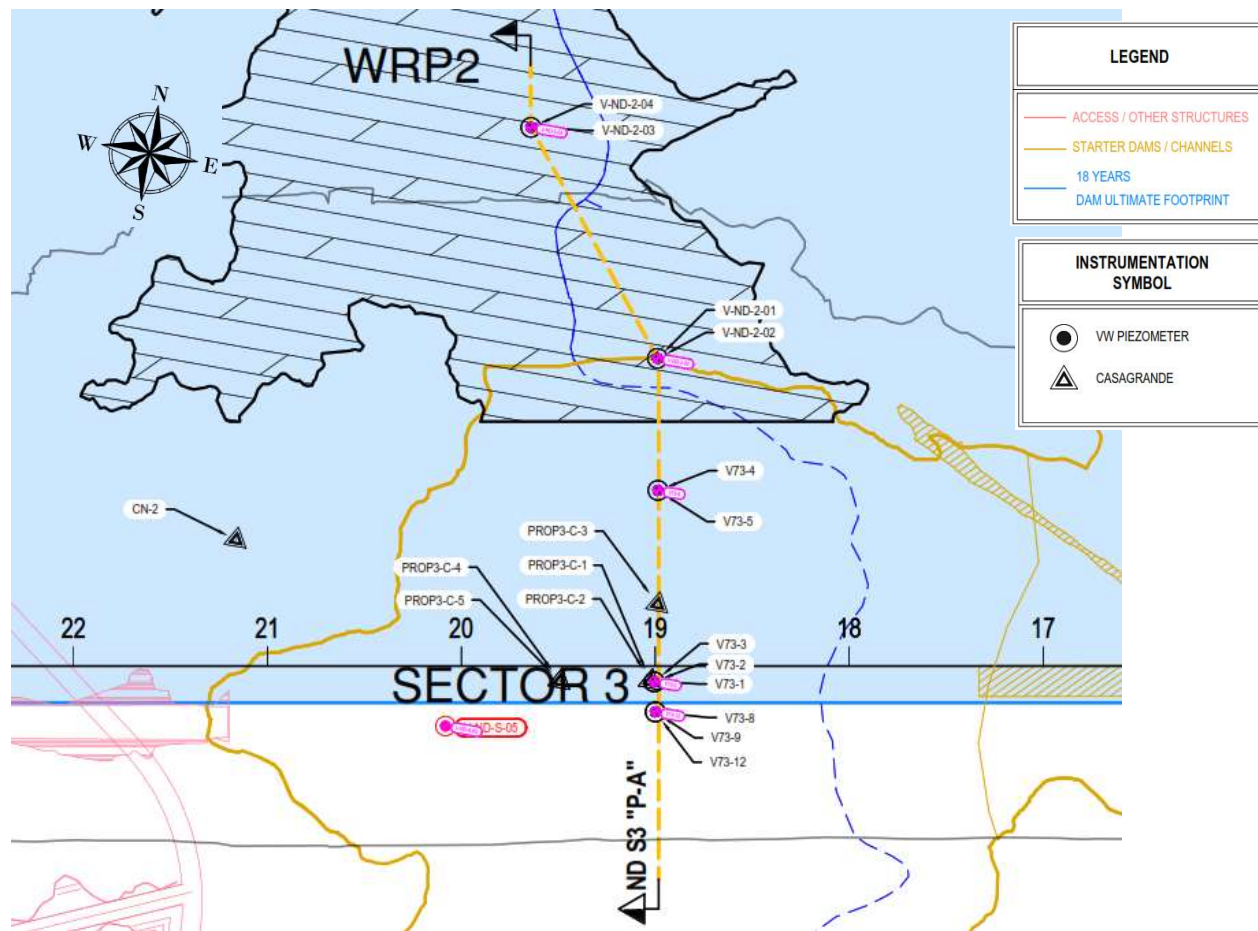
1: Vista en planta del sector 3 de ND - Grupos de instrumentos Piezometro y Casagrande
